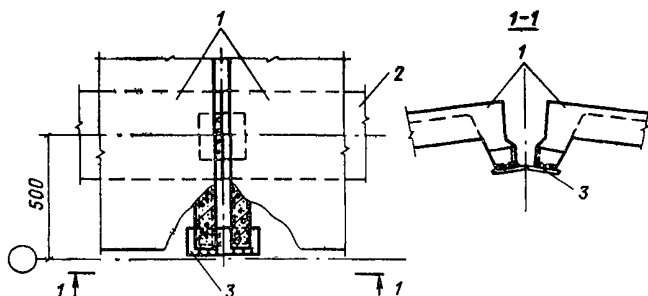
Крепление плит покрытия к стропильным конструкциям, расположенным у торца или антисейсмического шва здания
